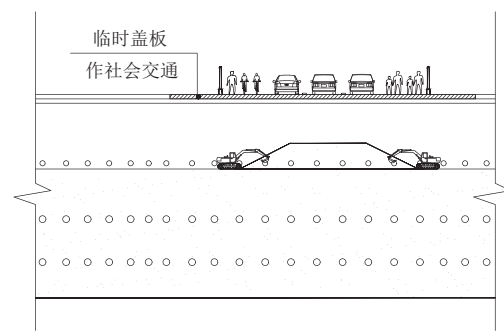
金牛山站主体施工场地布置及交通组织剖面示意图
